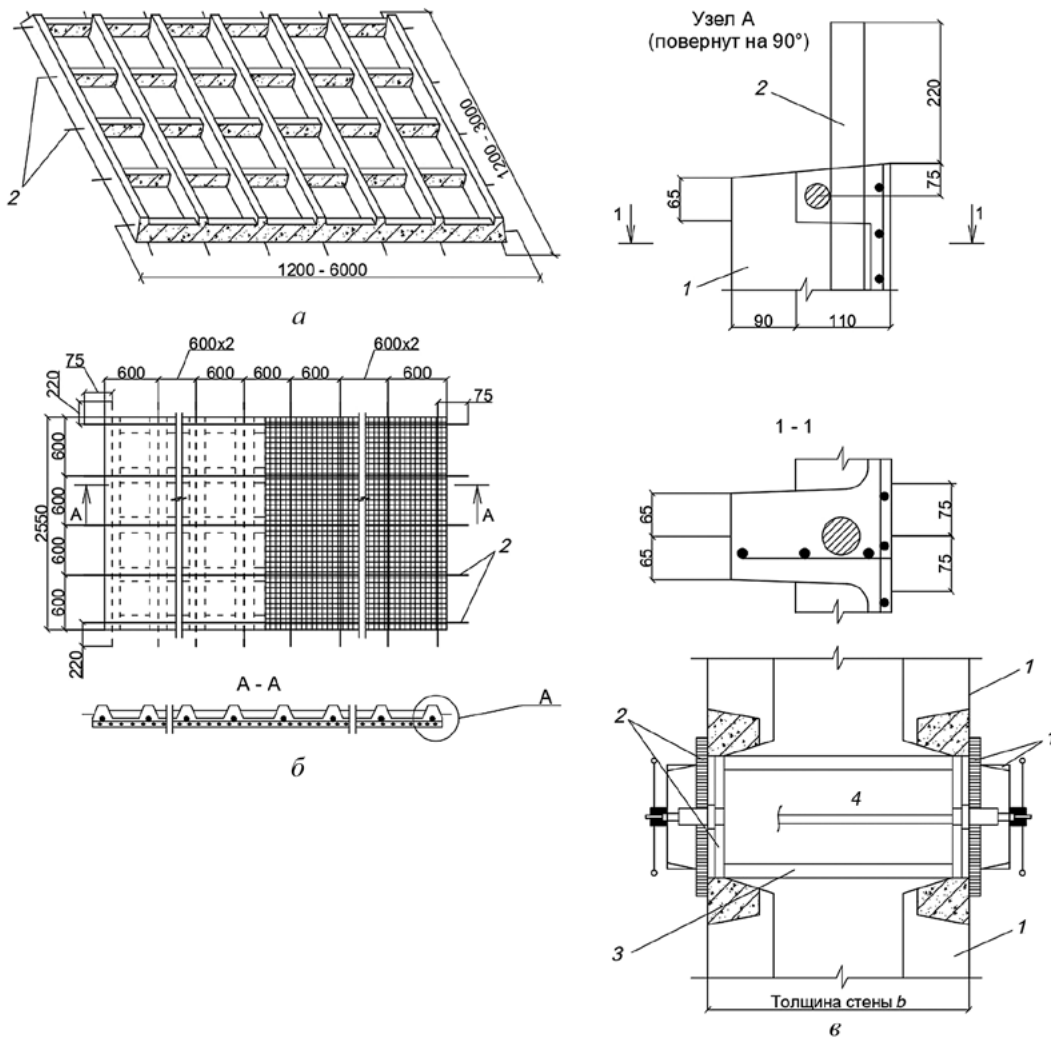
Ребристая железобетонная плита несъемной опалубки с выпусками арматуры: а — общий вид плиты; б — арматурно-опалубочный чертеж плиты; в — узел соединения плит; 1 — плита; 2 — выпуски арматуры; 3 — связи из уголков, объединяющие две плиты в стеновой блок; 4 — элементы съемной опалубки, устанавливаемые в стыках между плитами
